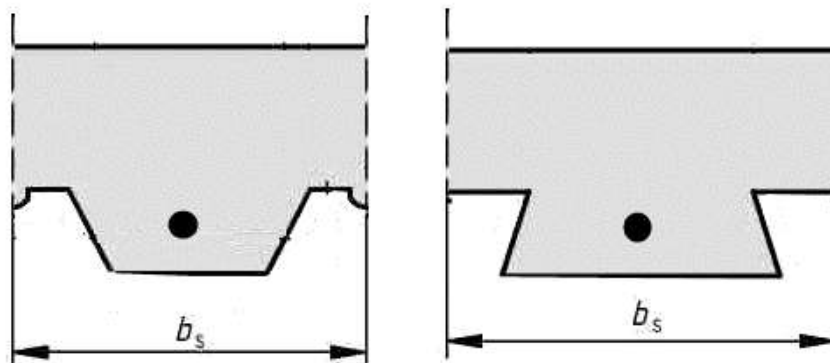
Расчетное сечение плит на вертикальный сдвиг
